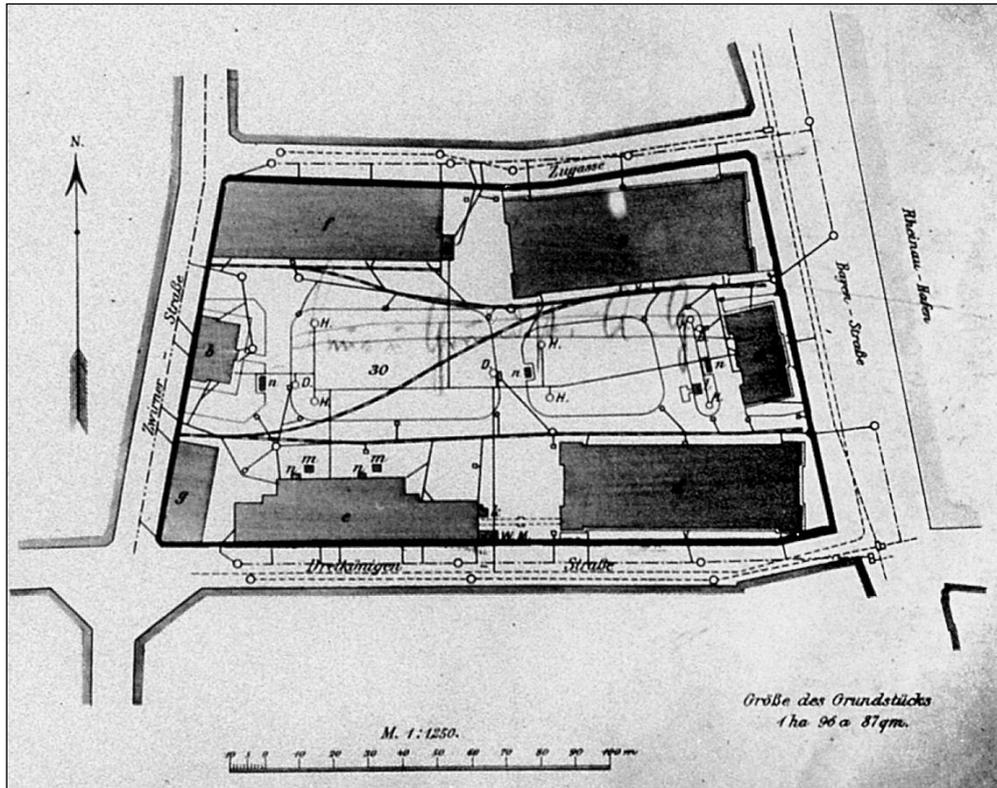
Lageplan des Proviantamtes an der Bayenstrasse 45-47. Rechts die Bayenstrasse mit dem Amts- und Dienstwohngebäude, das von den großen Speichergebäuden an den Ecken Dreikönigenstrasse (unten) und Zugasse (oben) flankiert wurde.
